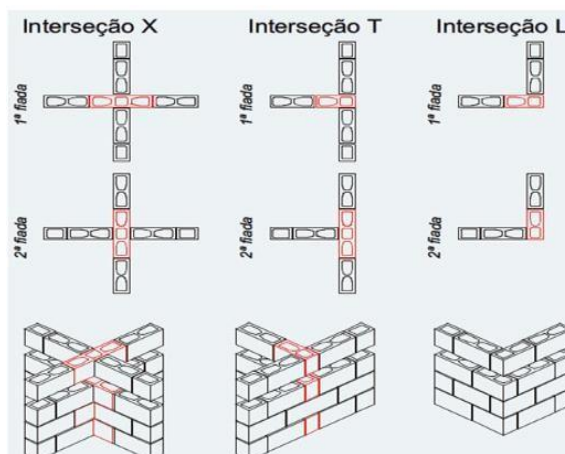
Família 39 e 29 dos blocos de concreto estrutural.
